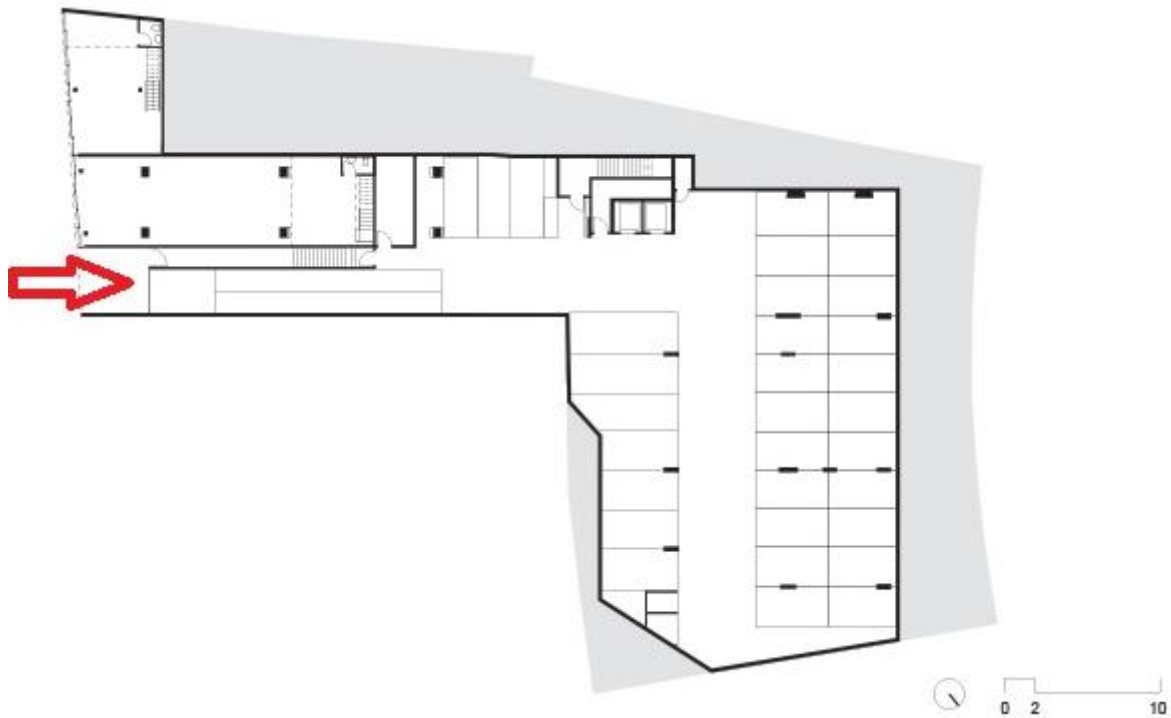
Planta de acceso por la Rua Simpatia. Planta editada a partir de la planta elaborada por Andrade Morettin Arquitetos (2016).
